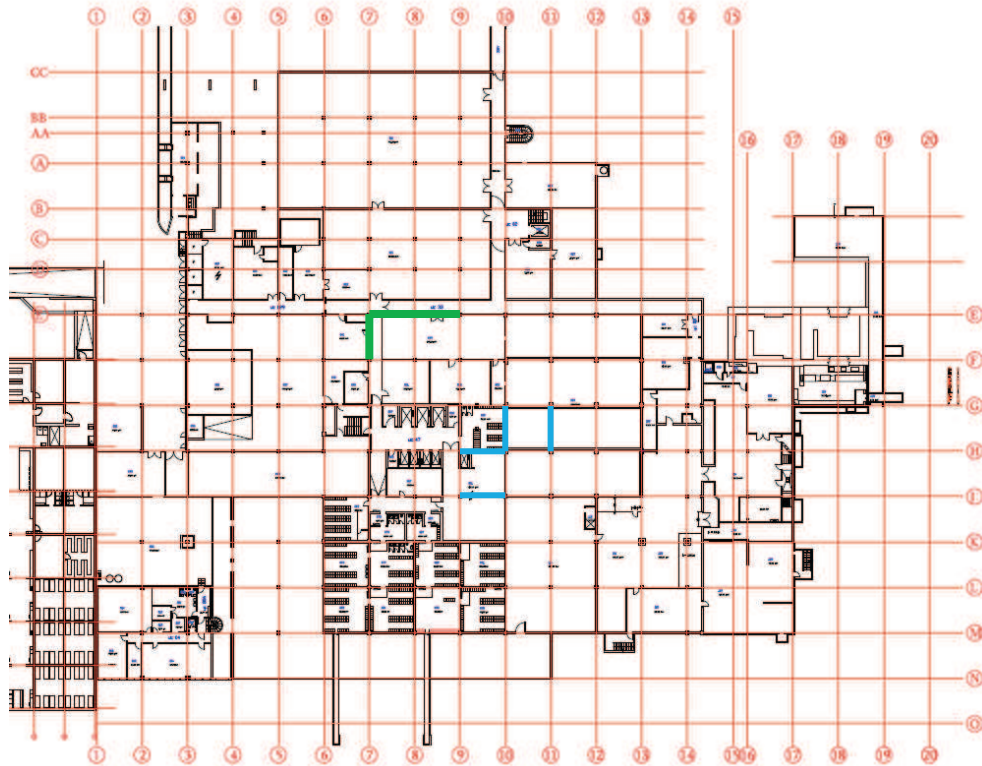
Plan du sous-sol, niveau U. Nouveaux murs en béton armé.
